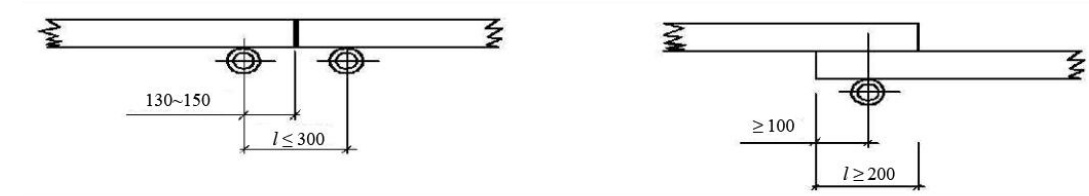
脚手板对接、搭接构造（单位：mm）
